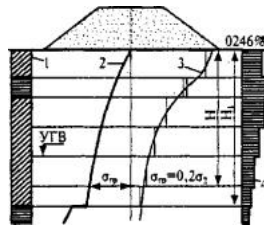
Расчетная схема вычисления осадки от сжатия грунта под насыпью:
